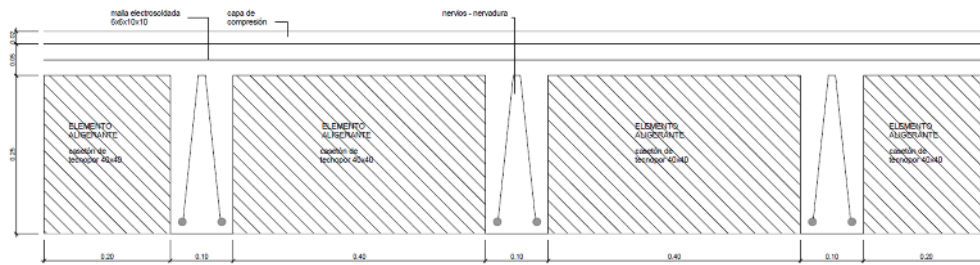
Detalle de losa nervada bidireccional. - Fuente: Elaboración propia
